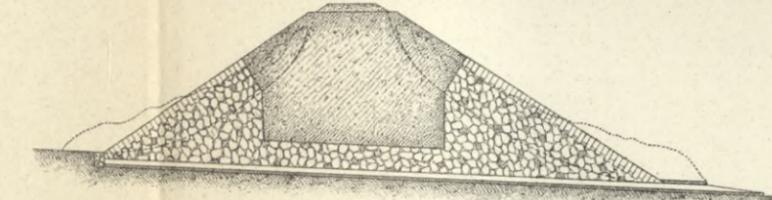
Dammrutschung an der ungarischen Ostbahn, Schutzdamm nebst Entwässerungsstollen. M. 1:750.
